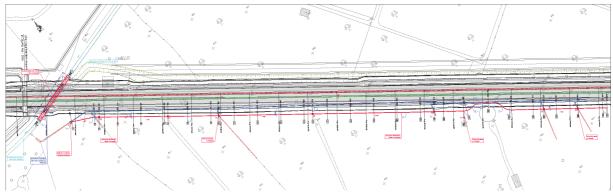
Condotta secondaria DN400 - Stralcio Planimetrico
